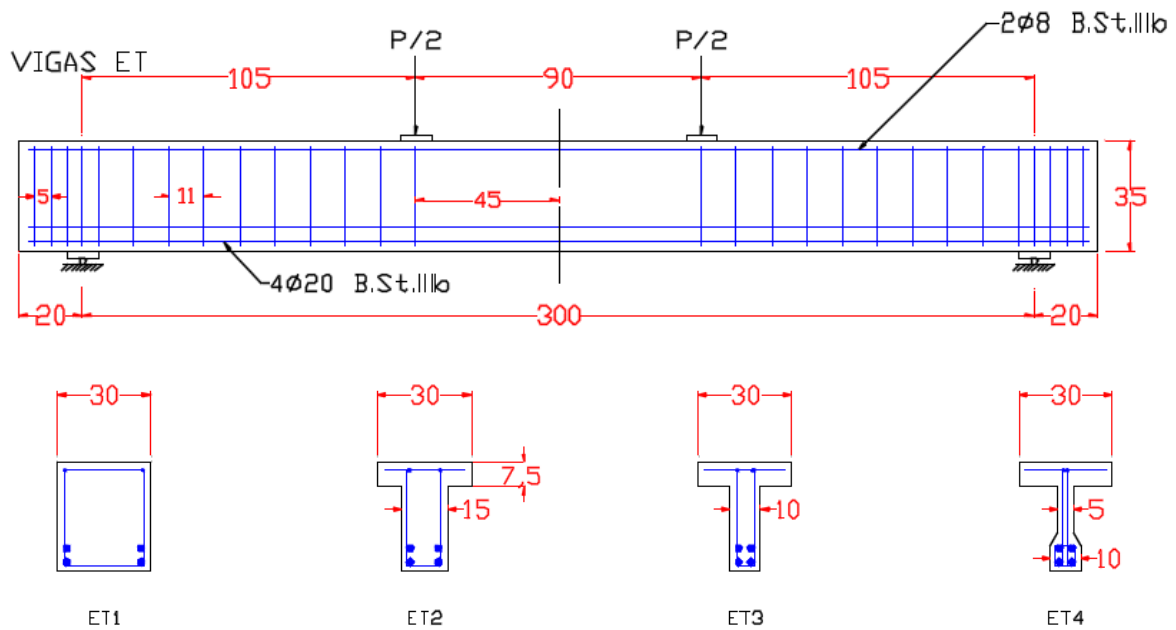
Vigas da série ET ensaiadas por Leonhardt e Walther (1962)
